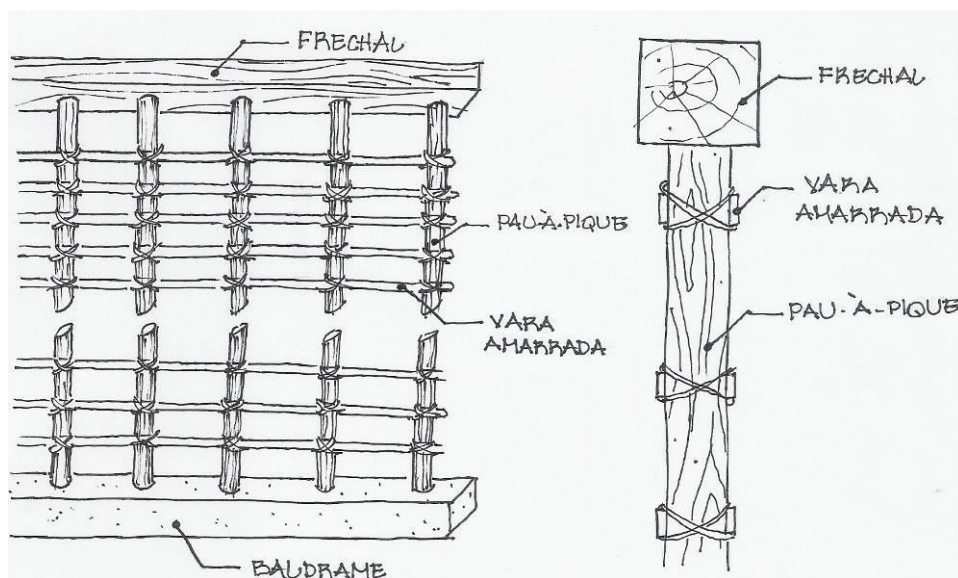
Esquema de montagem da estrutura de pau-a-pique e da amarração das varas horizontais de madeira.
